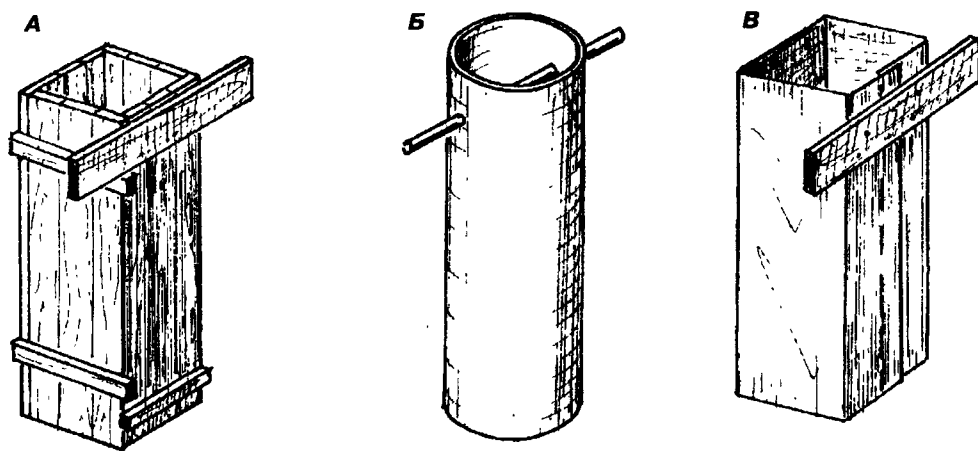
Трубы-опалубки для восстановления столбчатого фундамента:
